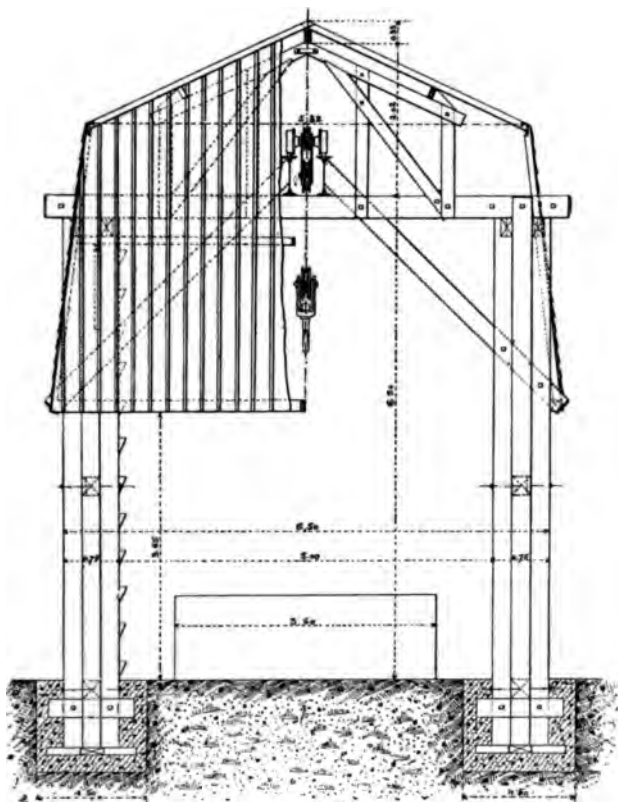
Vue par bout et demi-coupe de la charpente.
